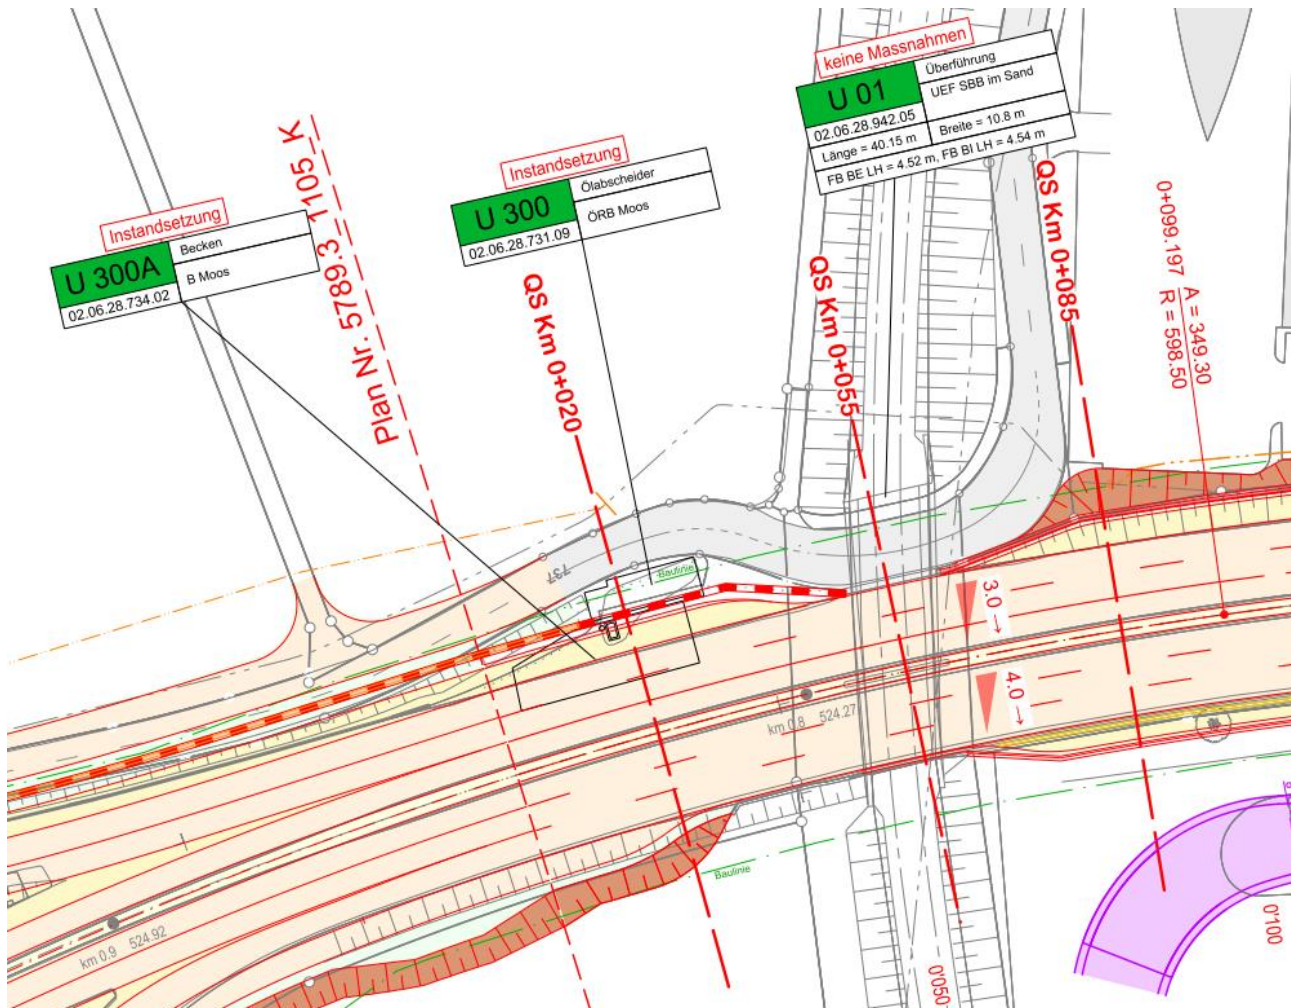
Ausschnitt Situationsplan Strassenbau Bereich UEF SBB im Sand
